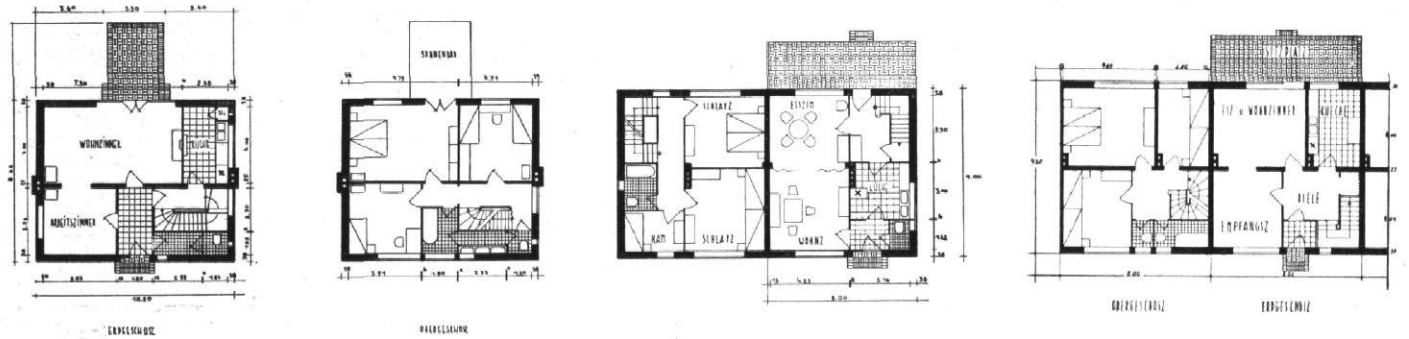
bis 28 / Siedlung Birkenwerder, Berlin / Architekt: Fritz Schopohl, Berlin / Grundrisse der Haustypen A, B und C. Maßstab 1:400
